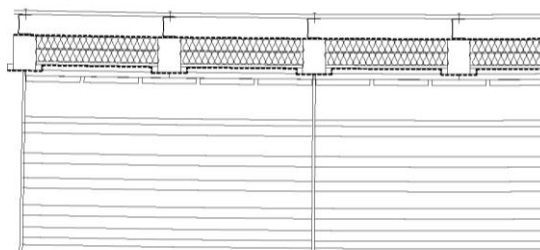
Sección tipo del muro con los parasoles. Documentación del proyecto.
